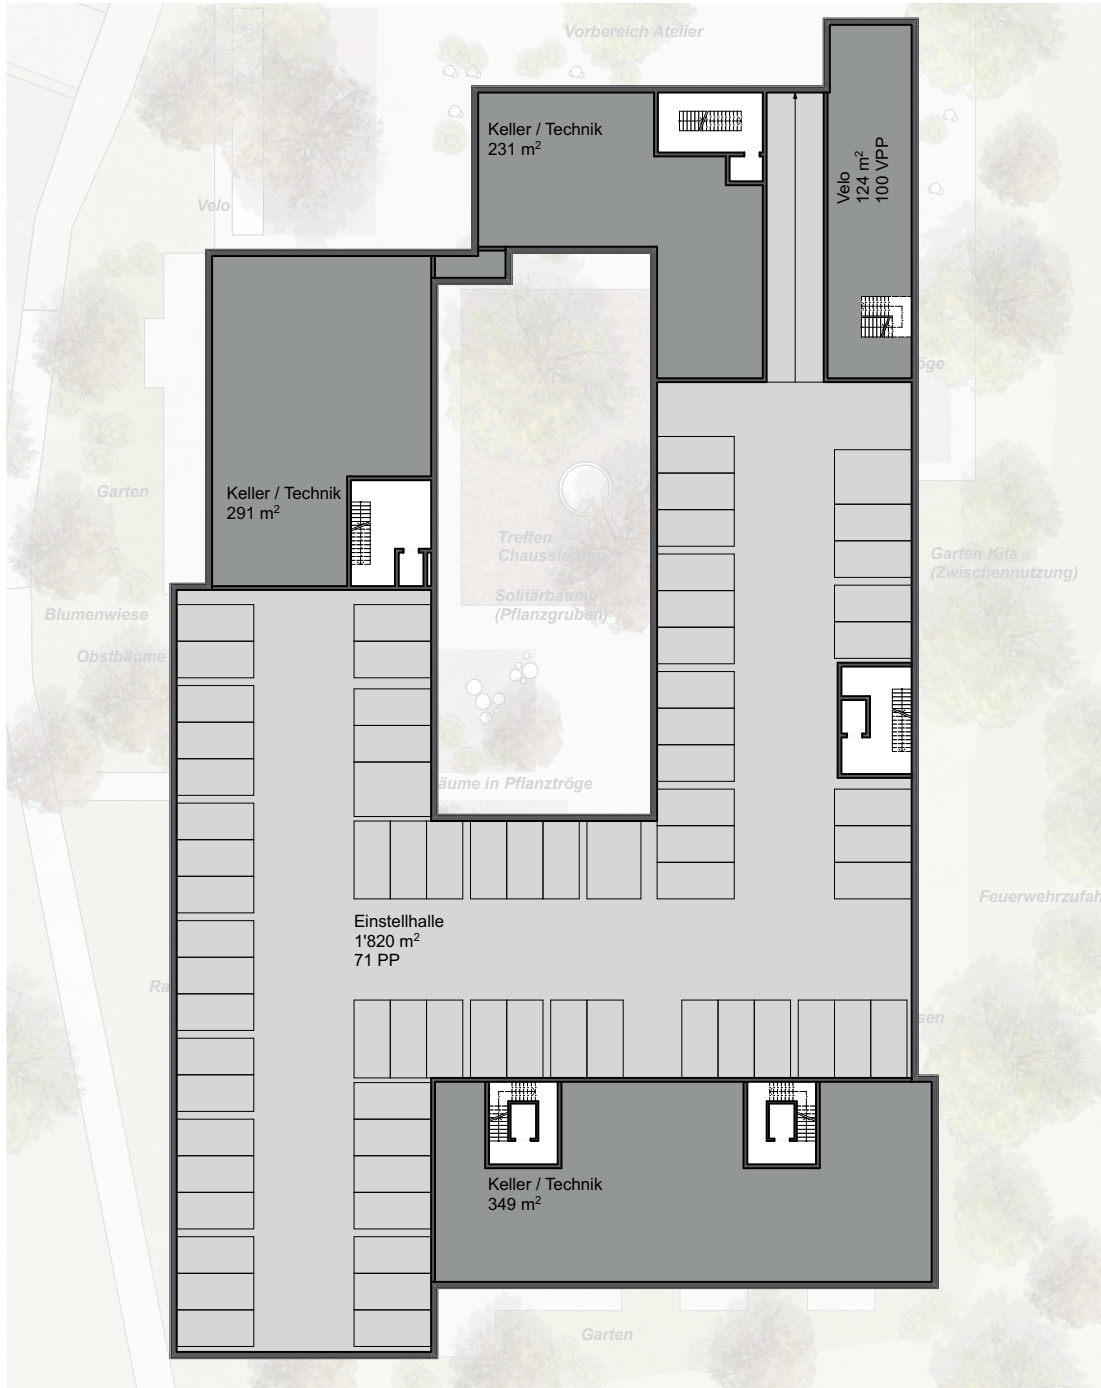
Untergeschoss mit unterirdischer Einstellhalle und Rampe
